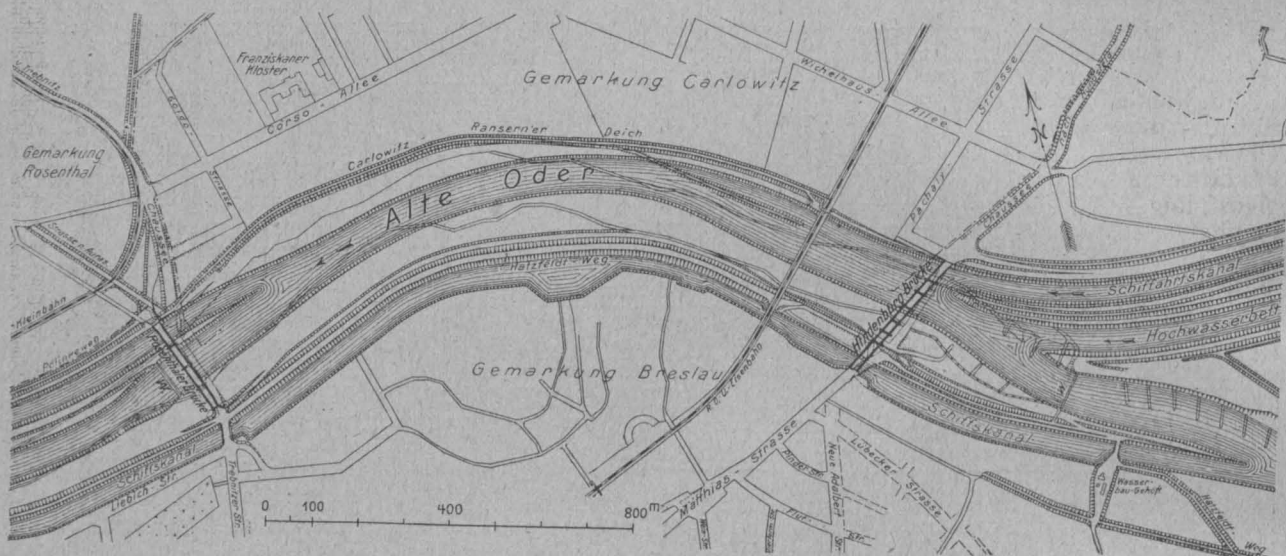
Lageplan der Oderstrecke mit den beiden Brücken.
